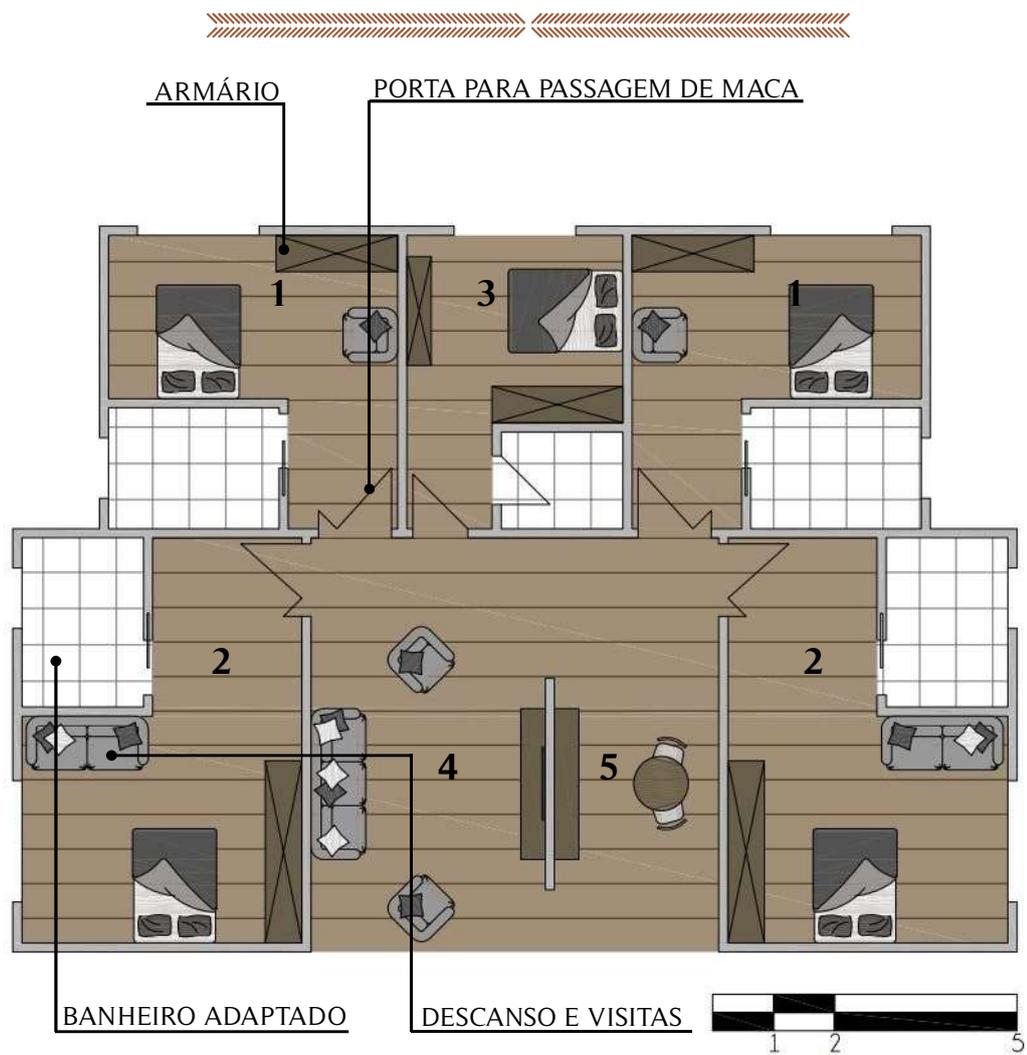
Proposta de layout dos núcleos de dormitório. Fonte: Da autora (2017).
